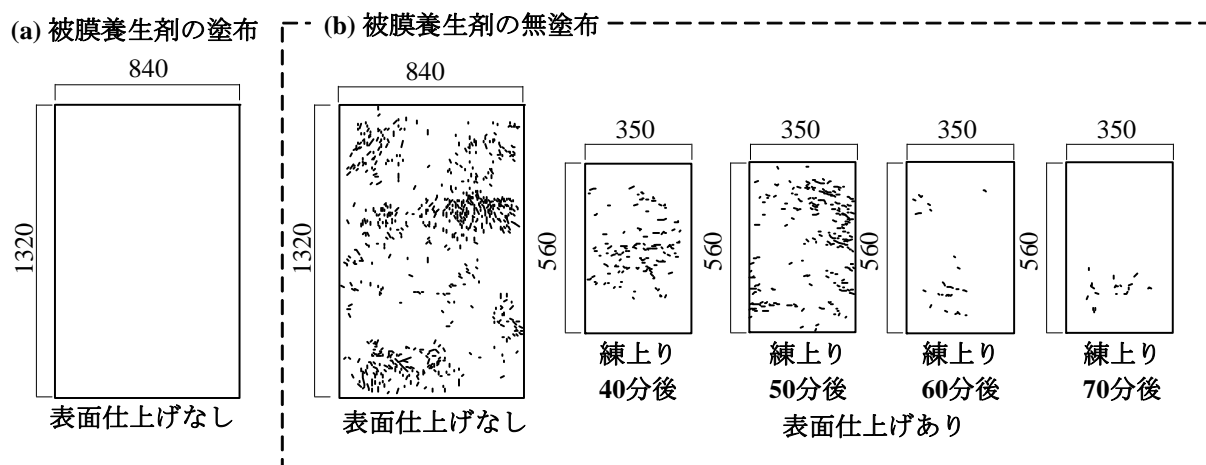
被膜養生剤の有無や仕上げタイミングの違いによる初期ひび割れの発生状況
